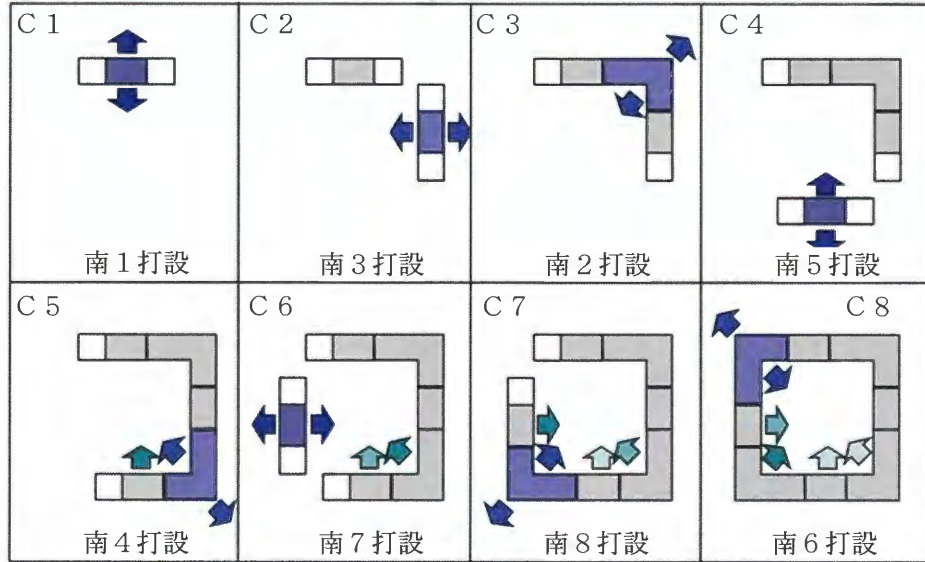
構築ステップごとのコンクリート打設に伴う地盤への施工圧力の蓄積履歴（南基礎）
